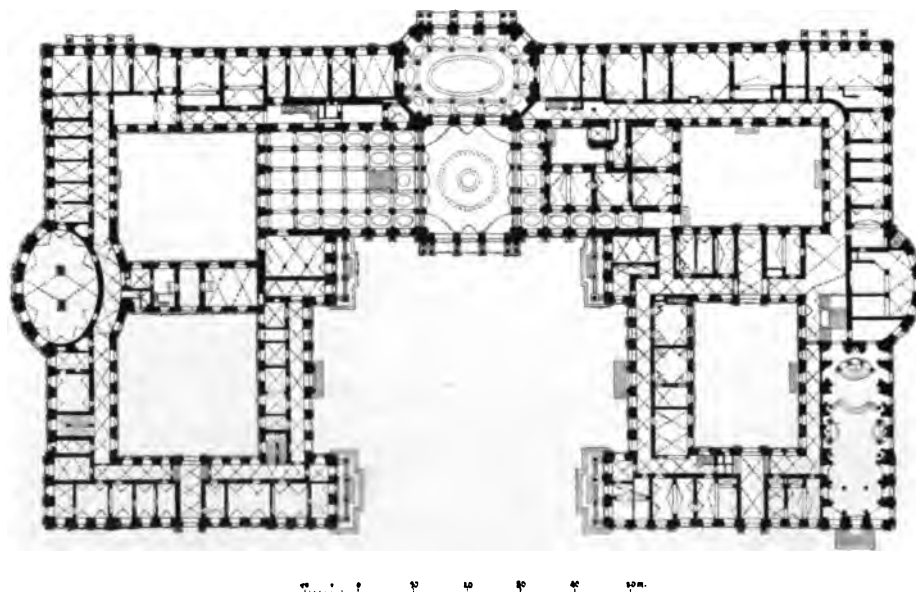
Grundriss des Erdgeschosses der Residenz zu Würzburg
